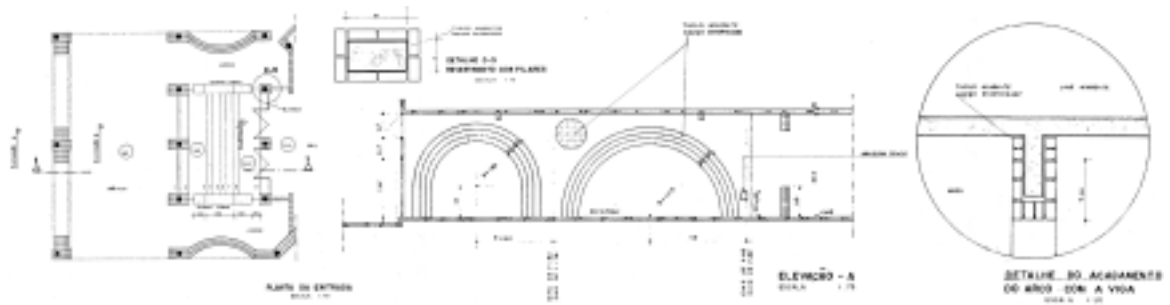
Revestimento da estrutura de concreto armado com tijolos maciços.
